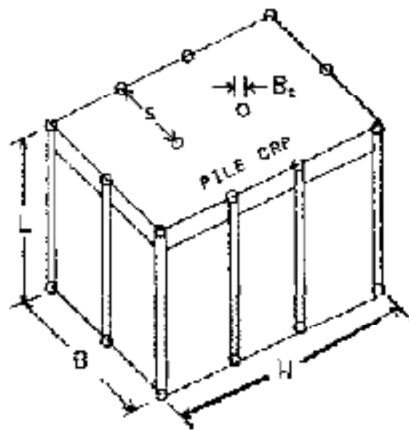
Esquema de un grupo de pilas (U.S. Army Corp of engineers, 1992,p.5-44)
